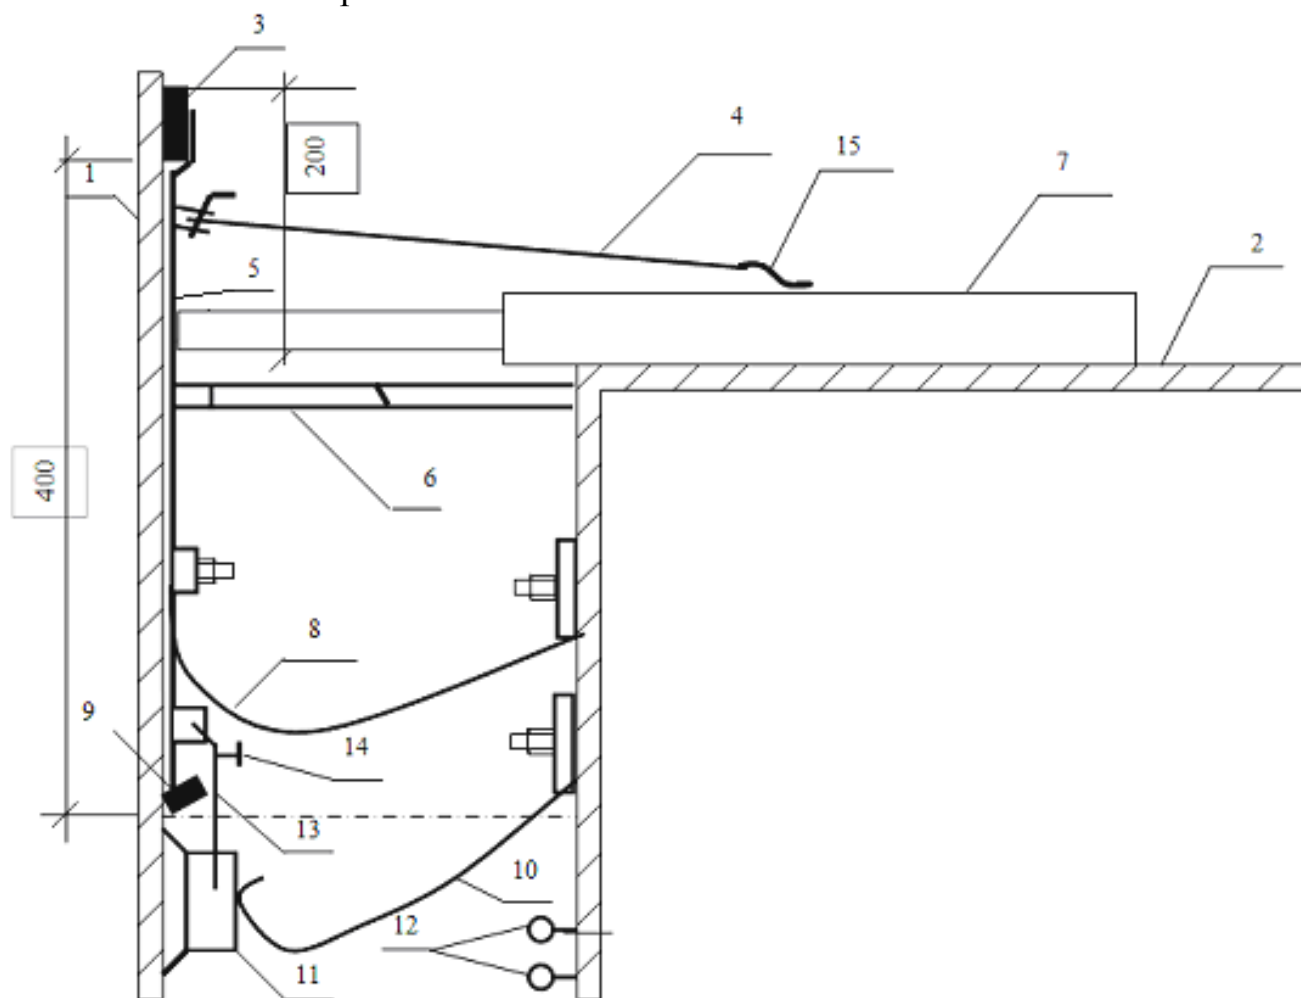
Конструкционная схема уплотняющего затвора плавающей крыши резервуара с горизонтальной подвеской
